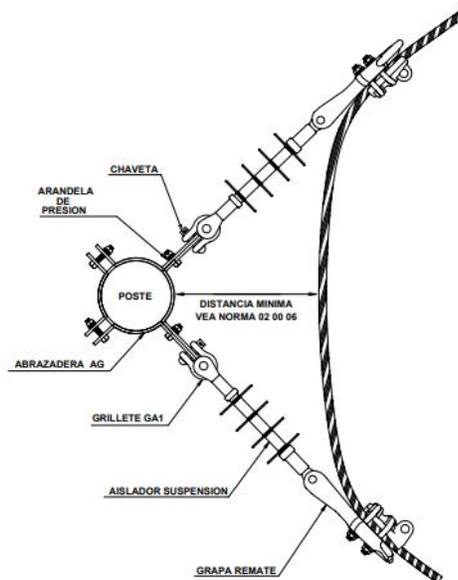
Abrazadera AG, grillete GA1 y aislador de suspensión
